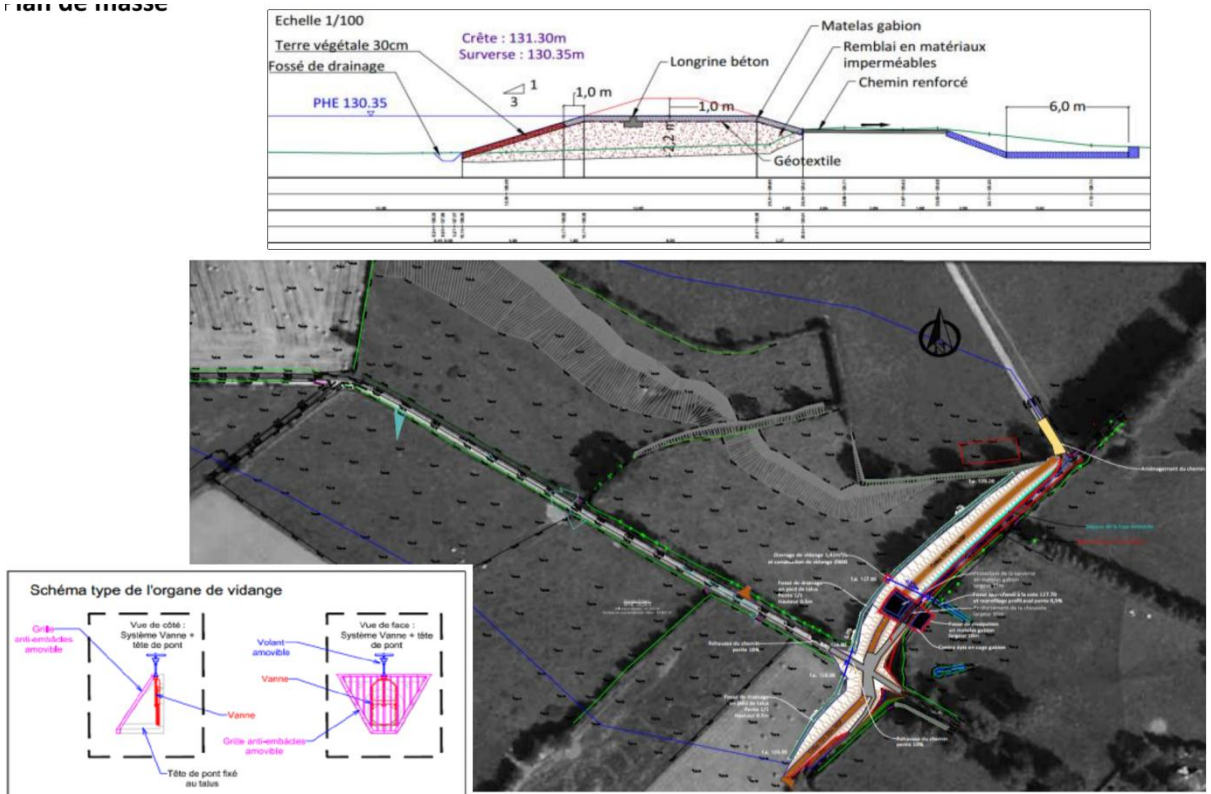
Extrait du plan de masse – Ouvrage E16-10
